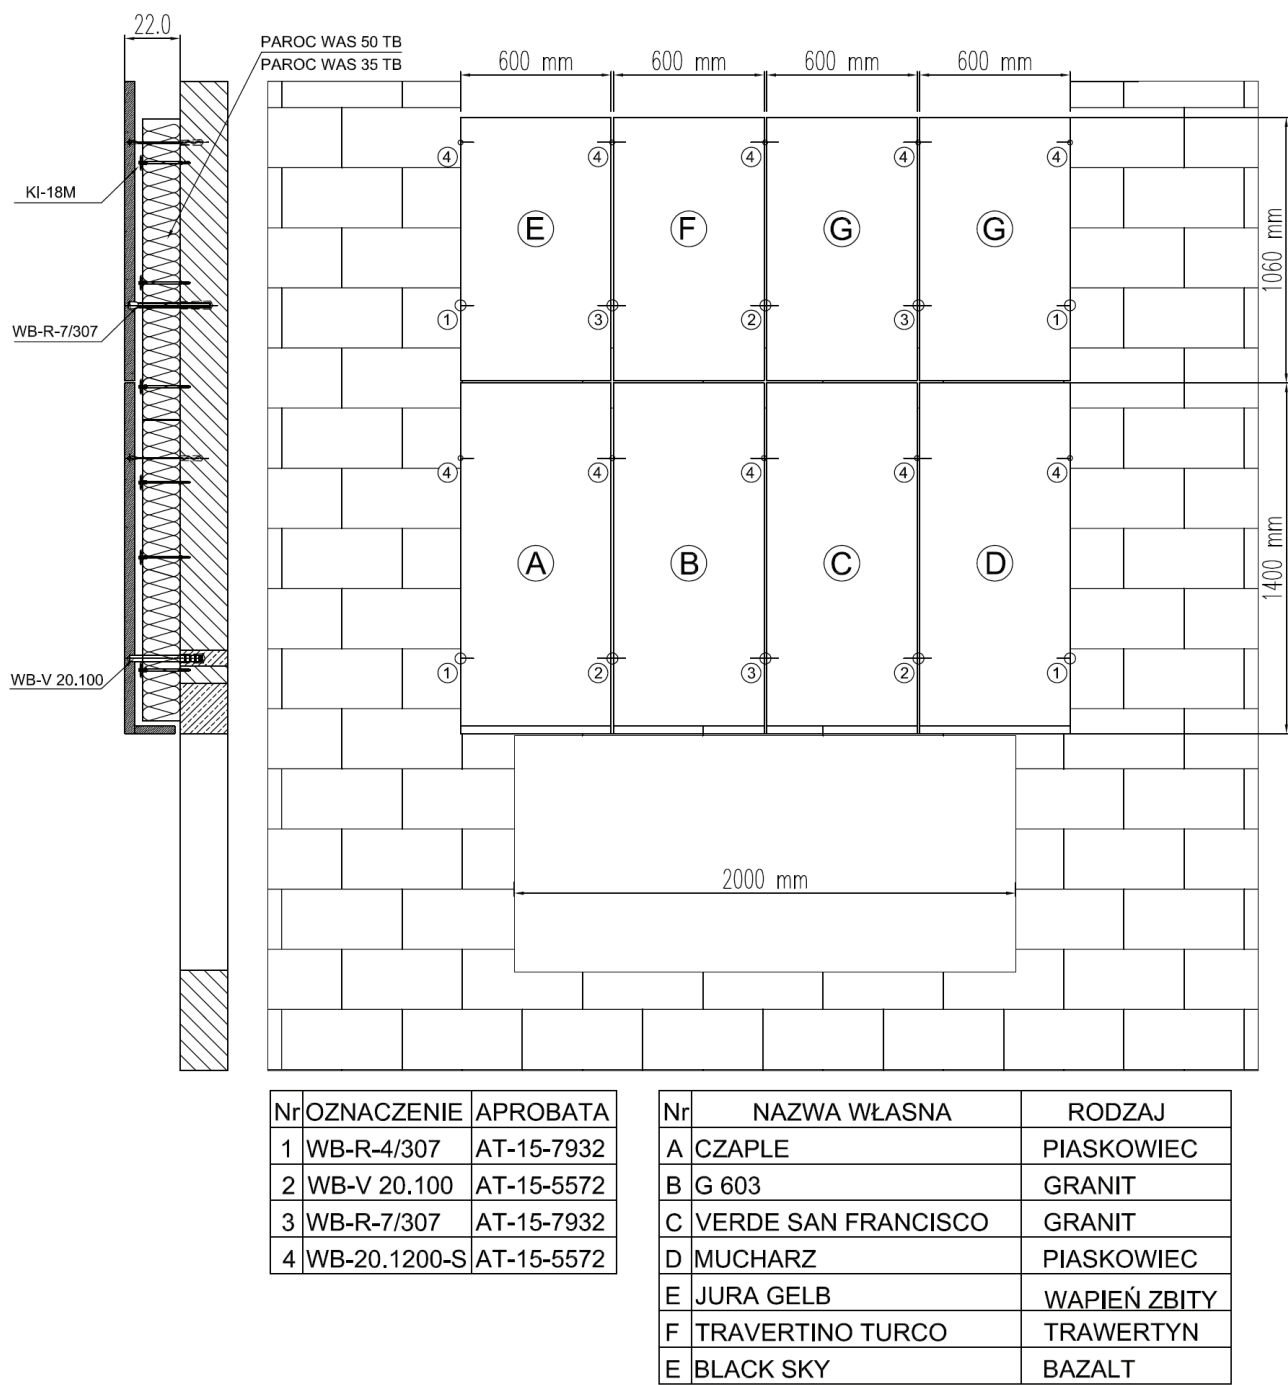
Mocowanie płyt elewacyjnych z zastosowaniem kotew WB-H
